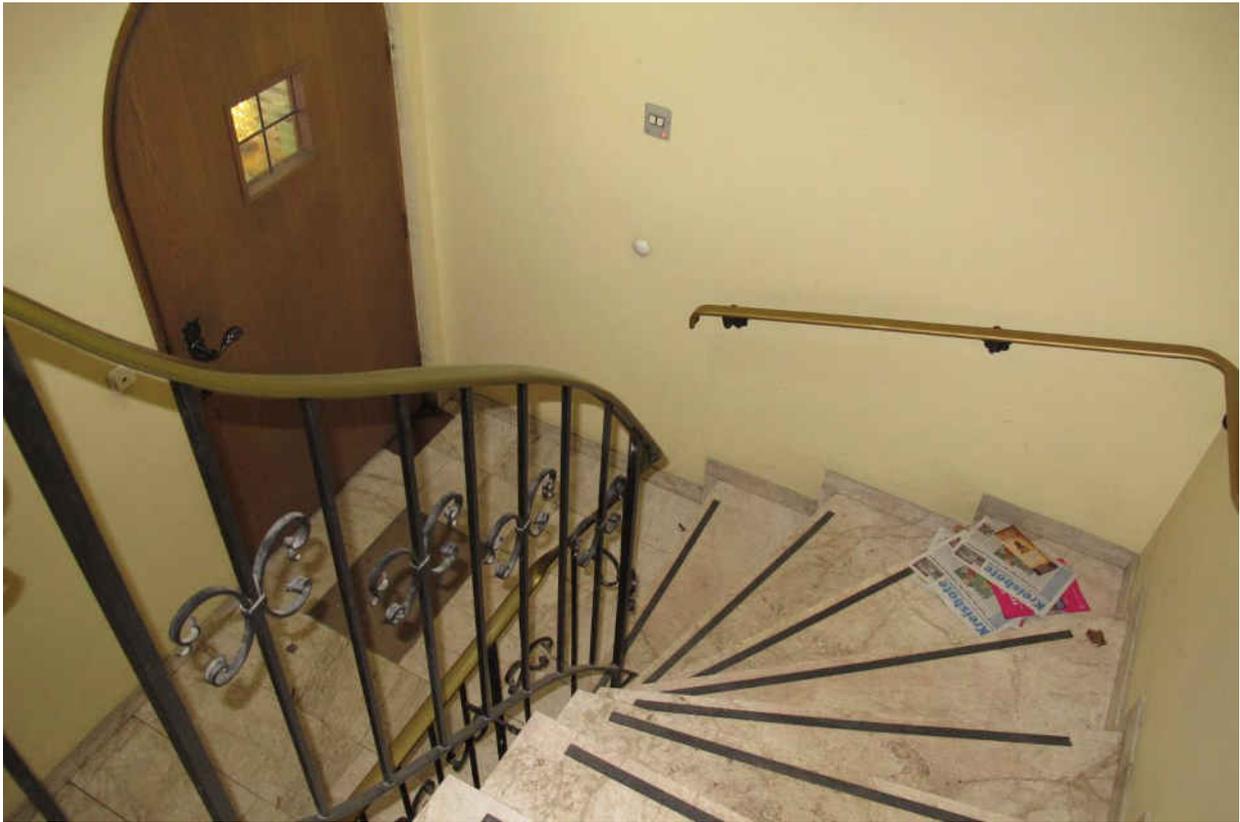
Treppenhaus mit Blick auf die Eingangstür
